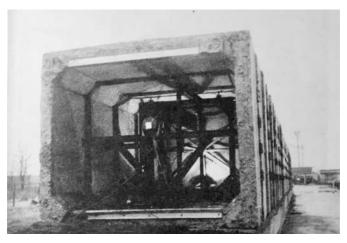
Резонаторный мембранный излучатель «Резонатор» (вид со стороны привода резонатора).
